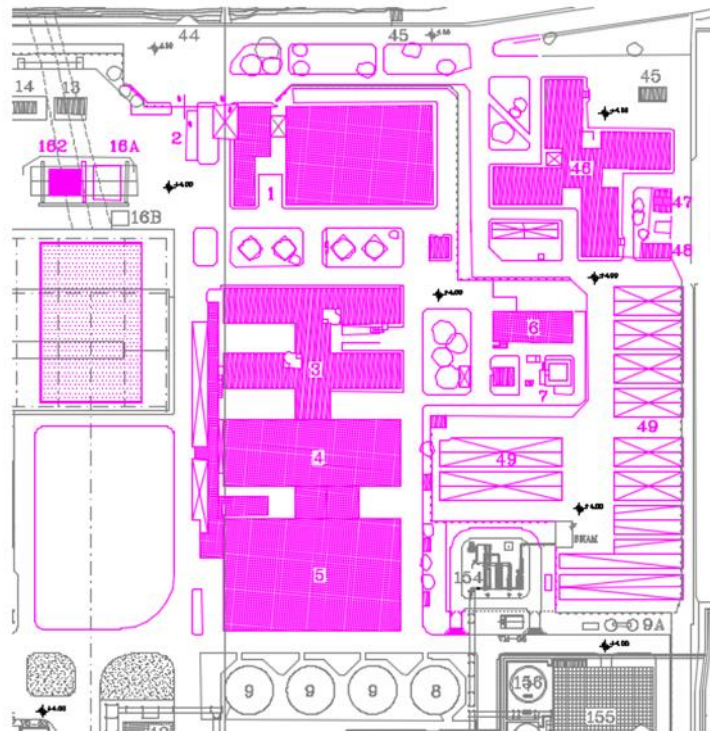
Posizione planimetrica delle opere da demolire
